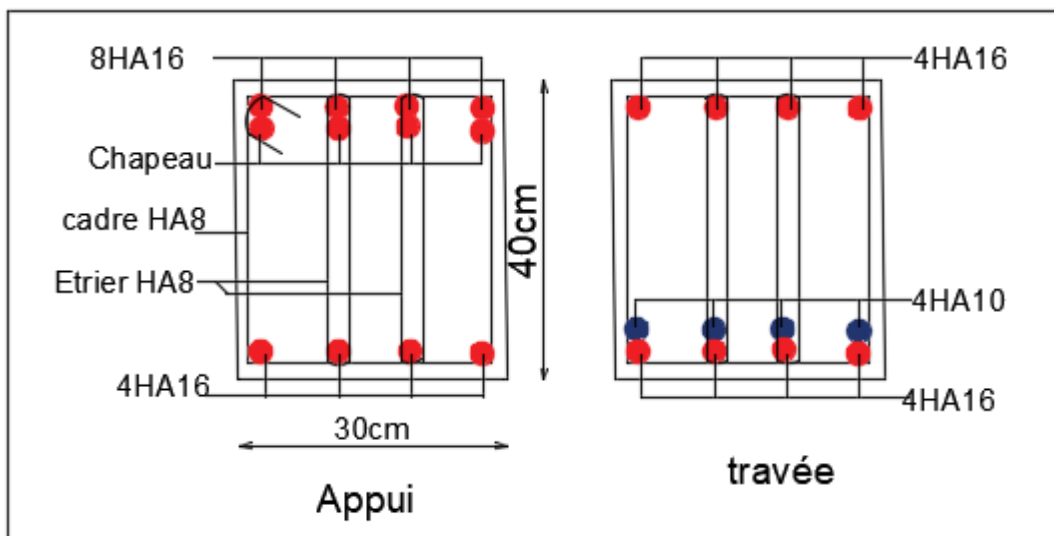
Schéma de ferrailage de la poutre principale du plancher étage 4, 5 ;
